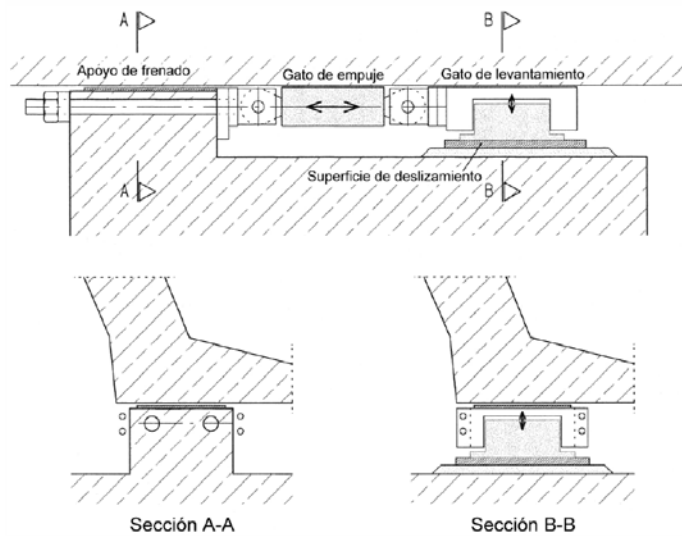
Dispositivo de empuje por rozamiento. (Fontán, 2009).
